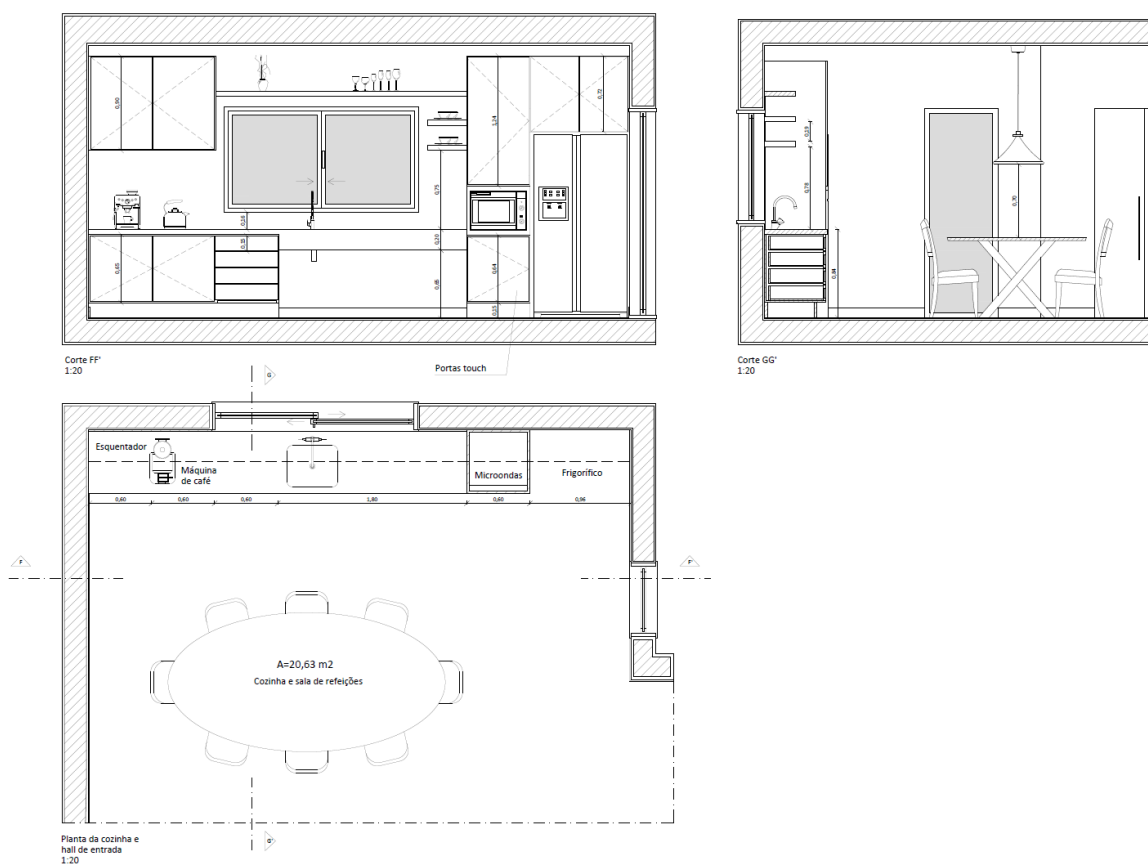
Planta de pormenorização da cozinha e sala de refeições. Fonte: Marisa Francisco.
